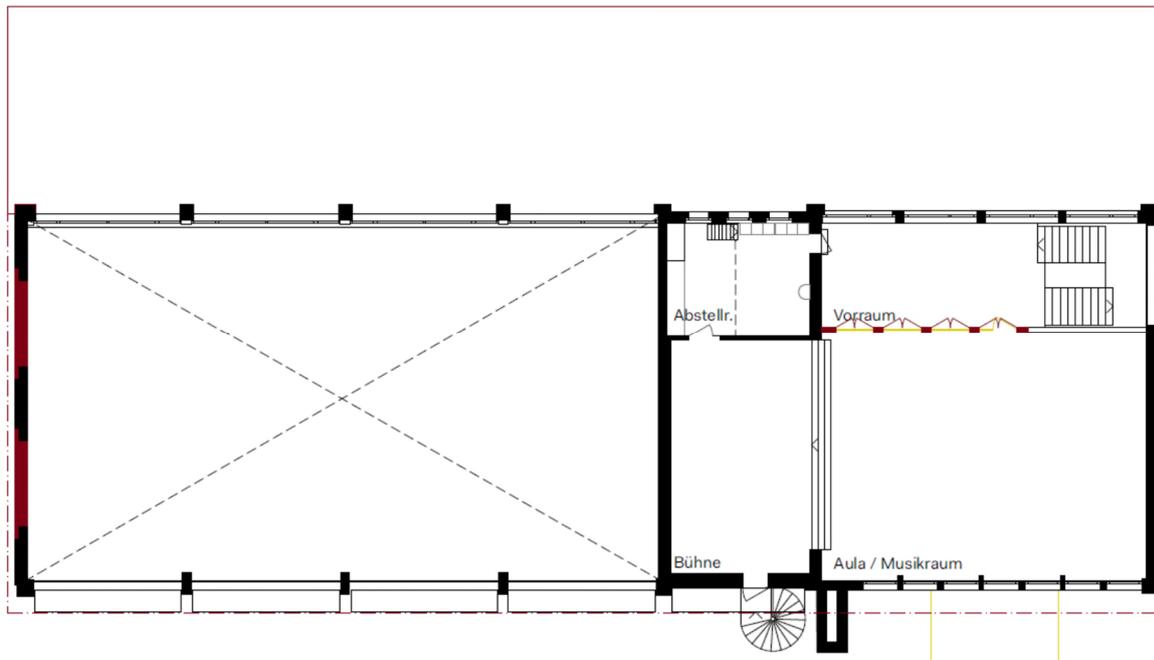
Hallenrakt – Obergeschoss mit Aula und Luftraum Turnhalle
